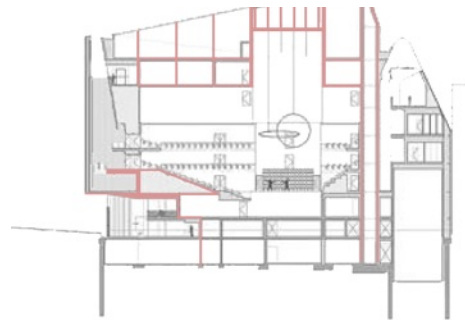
Teatro configurable. Sección con elementos constructivos destacados.
